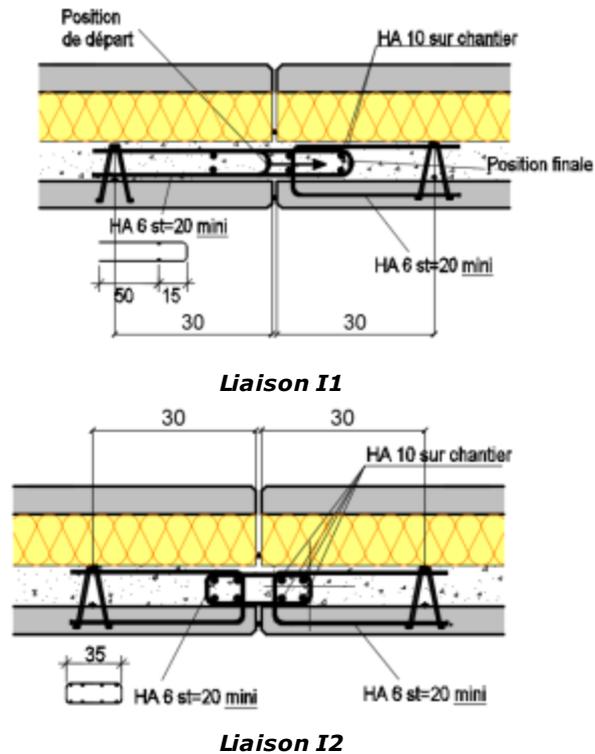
LIAISONS ENCASTREES PLANCHER MUR
